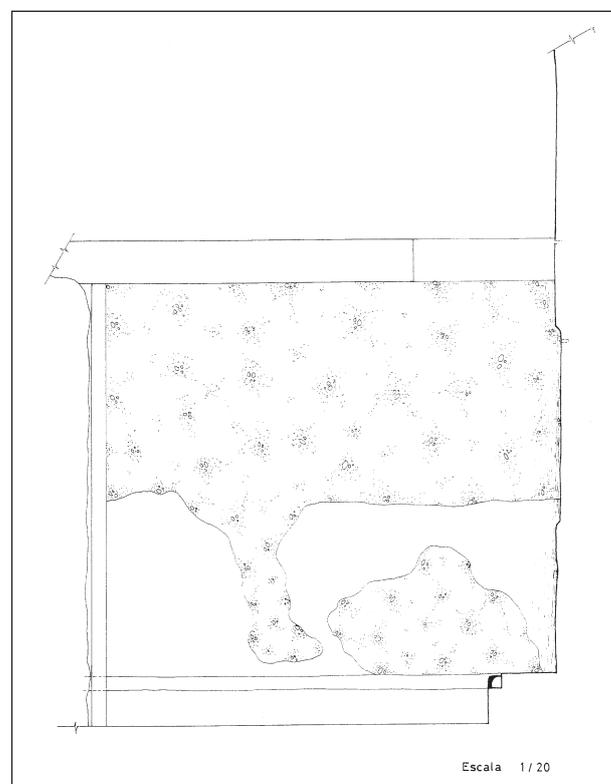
Lienzo de muralla nº 1. Alzado Este. Planta baja (Casa de los Rosendos).
